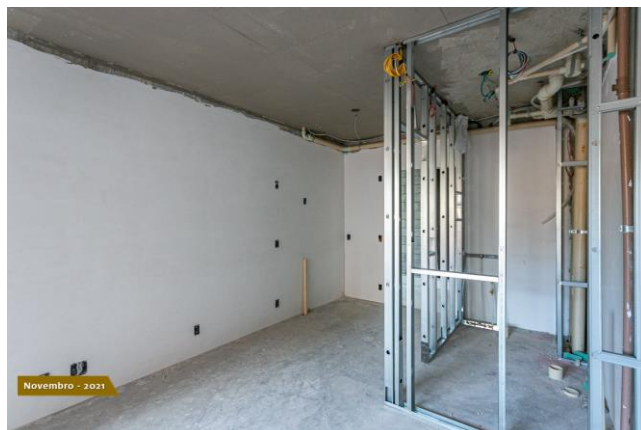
Alvenaria com acabamento e estrutura de dry wall.
